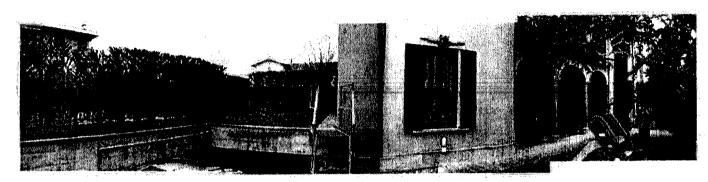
Rilievo esterno La facciata Sud del fabbricato con il portico di accesso agli alloggi ed il loggiato al primo piano.
